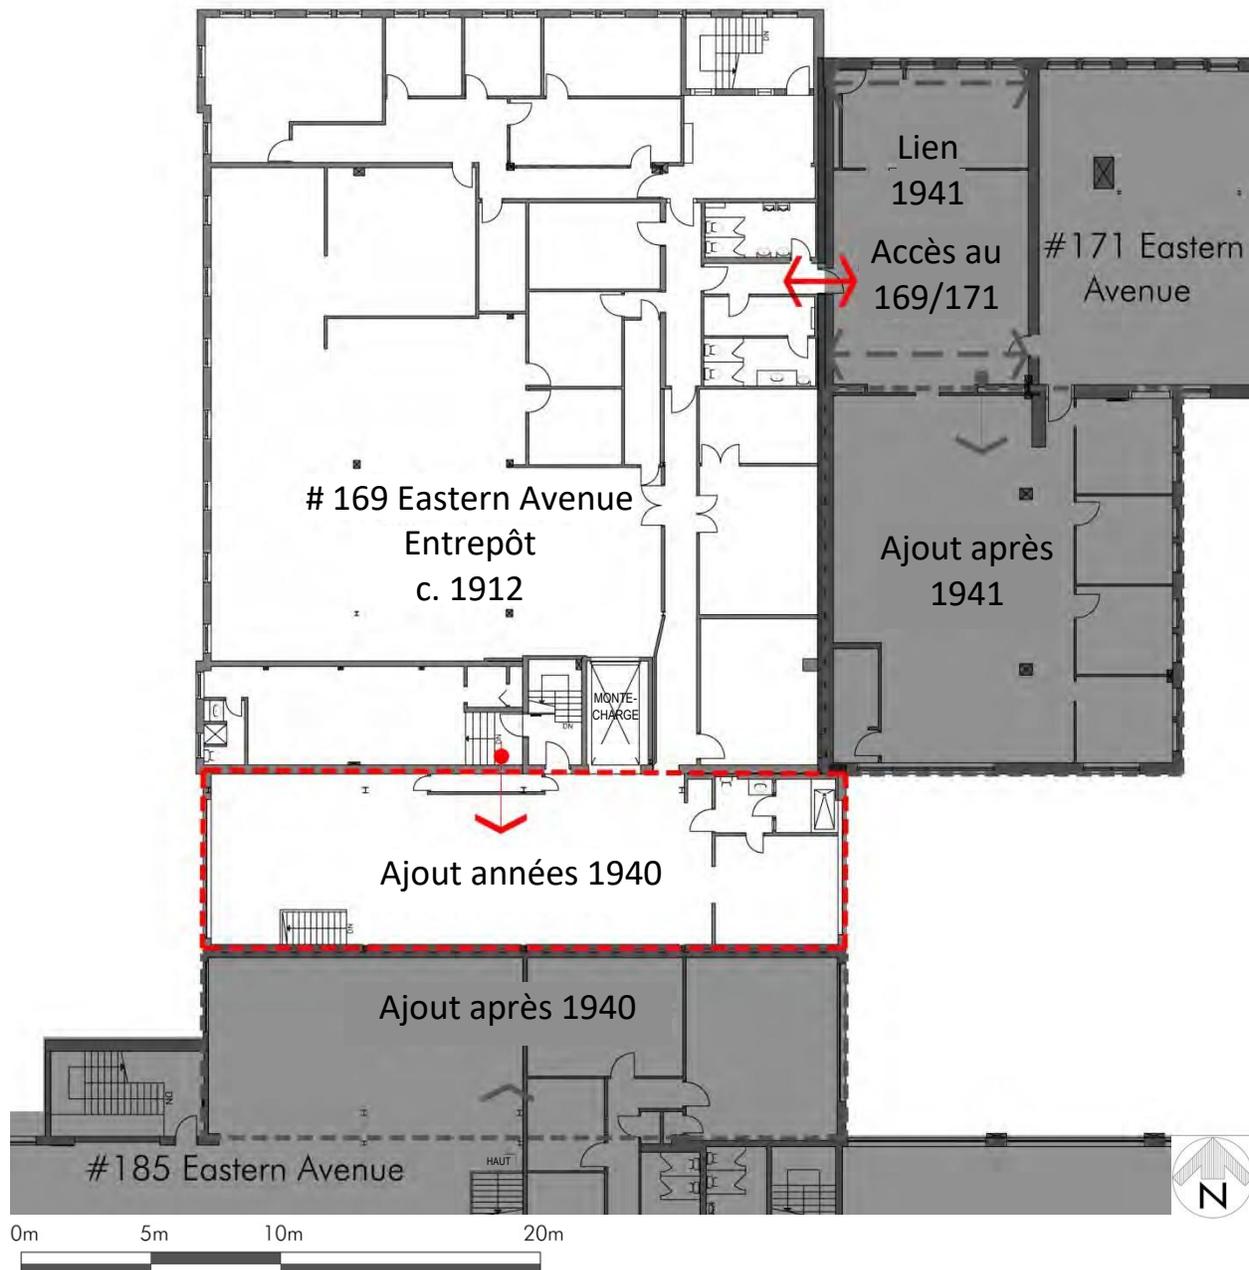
169 avenue Eastern – Plan du deuxième étage de l'entrepôt.
